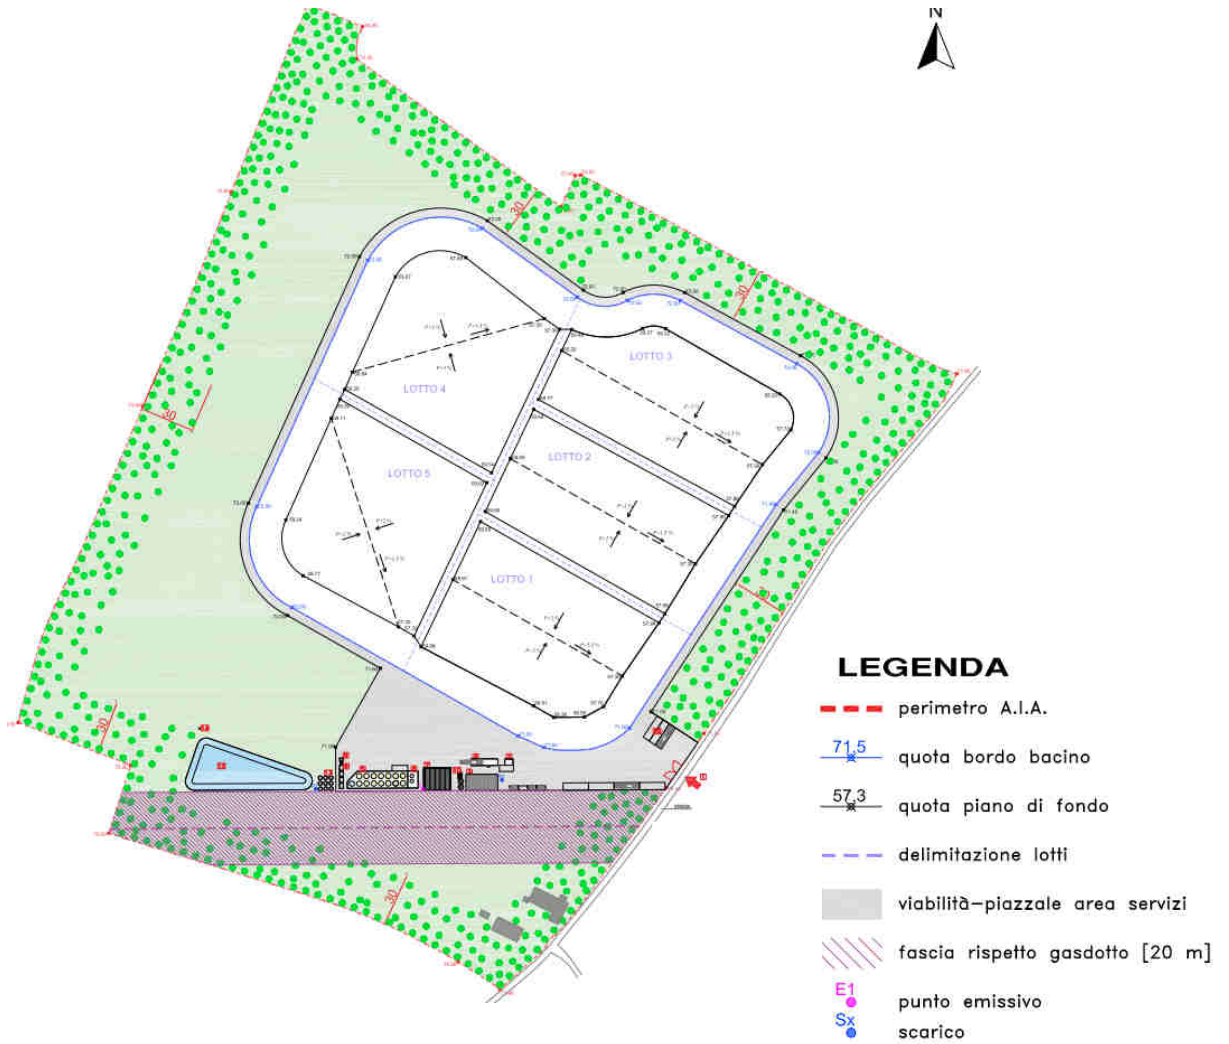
Piano di fondo della discarica in progetto [Fonte: estratto tavola P.04]
